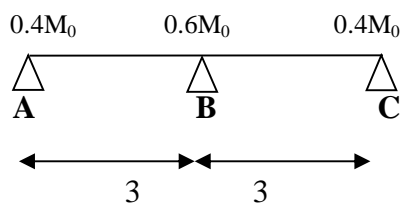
Schéma statique de la poutrelle à 2 travées.
